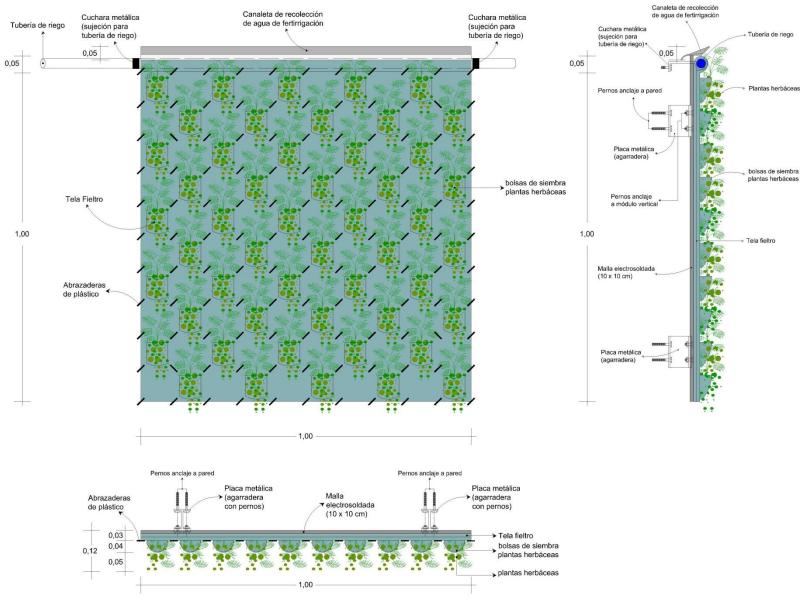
Detalle de panel modular (con plantas herbáceas) .Fuente: Eduardo Rivadeneira
